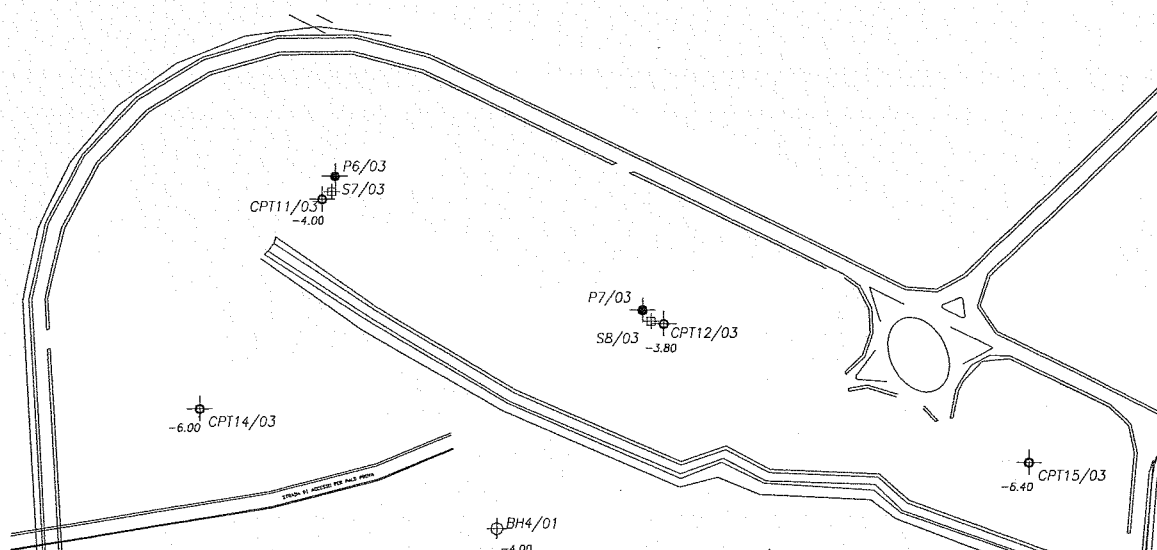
Planimetria con ubicazione delle indagini precedentemente eseguite
